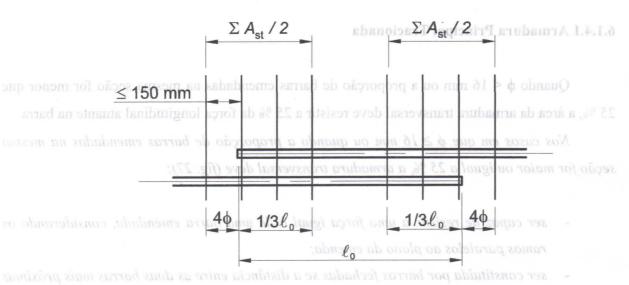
Disposição da armadura transversal nas emendas de barras comprimidas.
